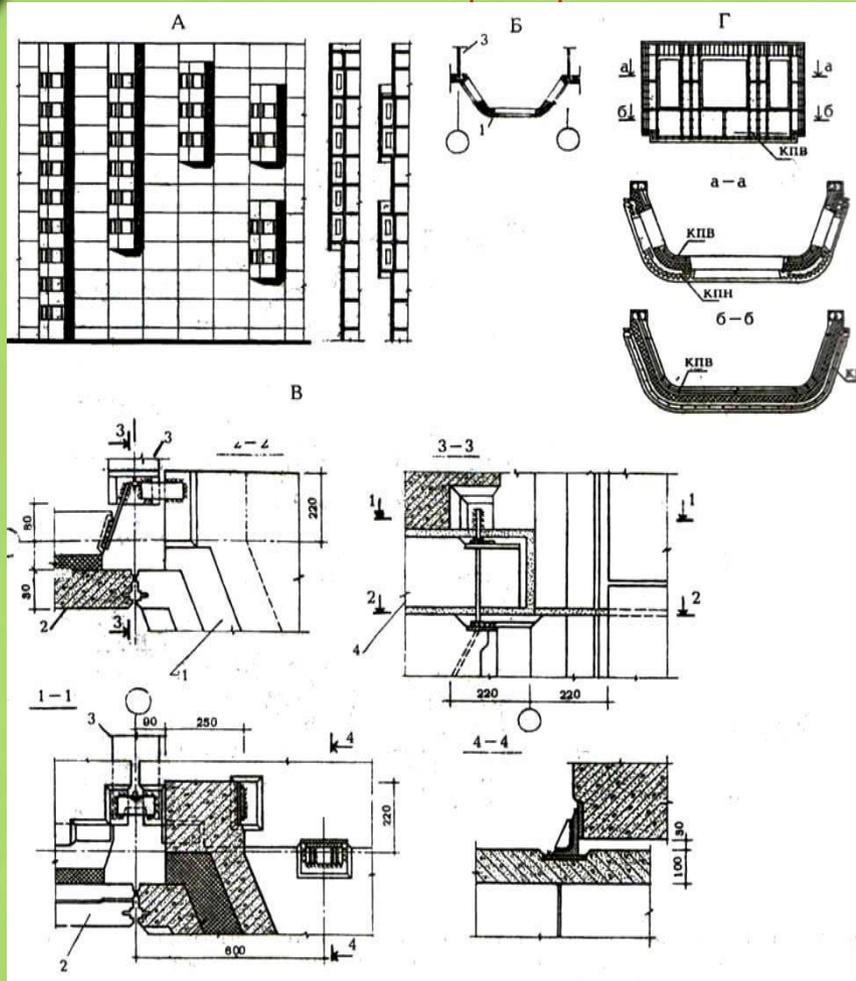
10. Объёмный эркер панельных зданий: А • схема компоновки на фасаде здания; Б * схема установки в плане; В - крепление объёмного элемента эркера; Г- схема армирования объёмного эркера; 1 элемент объёмного эдемента эркера; 2 - наружная стеновая панель; 3 - внутренняя стеновая панель; 4 - панель перекрытия; КПН, КПВ - каркас пространственного наружного (КПН) и внутреннего (КПВ) слоёв
